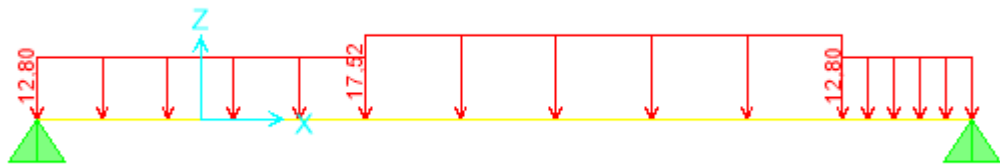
Schéma statique de l'escalier chargé le plus sollicité.
